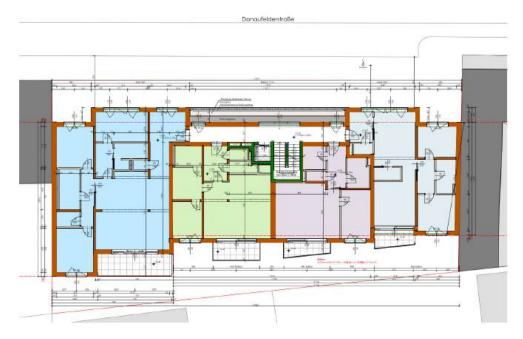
Grundrissdarstellung Regelgeschoß 22. Donaufelder Straße 174-178
